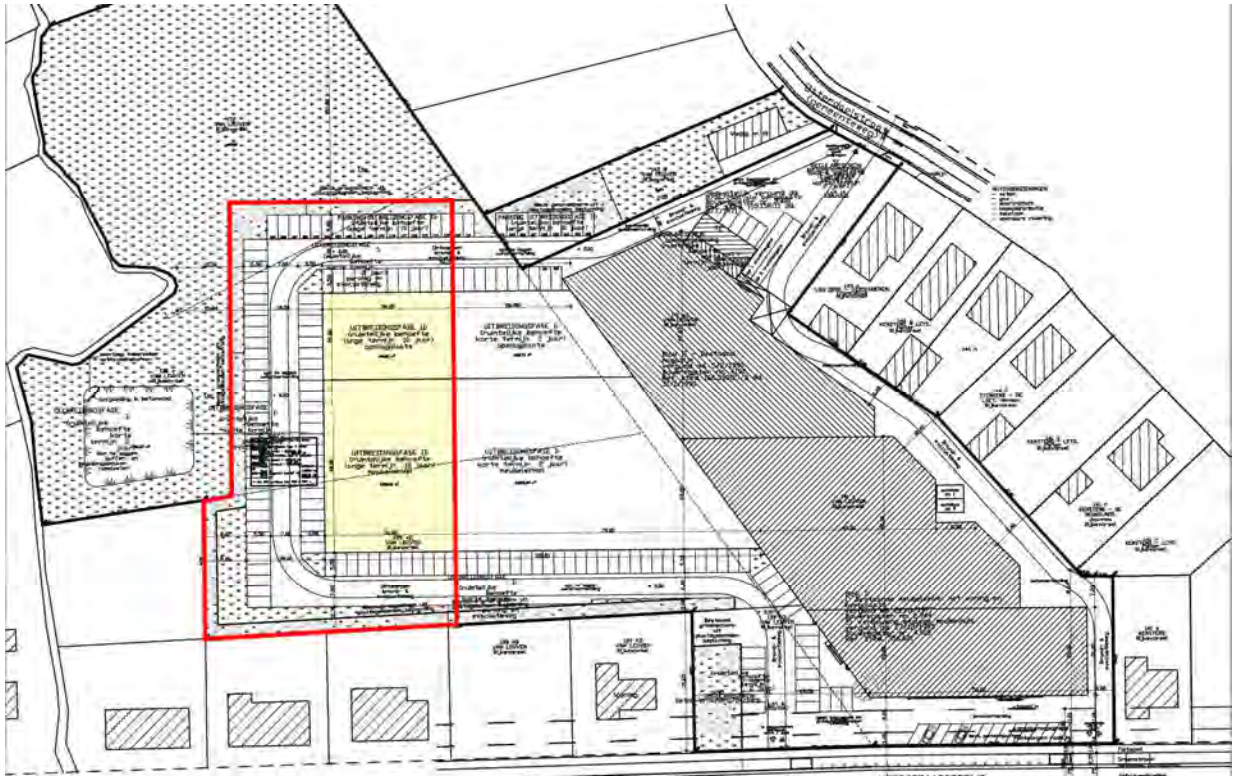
aanvraag uitbreiding korte termijn (bron: aanvraag planologisch attest - bewerking)
